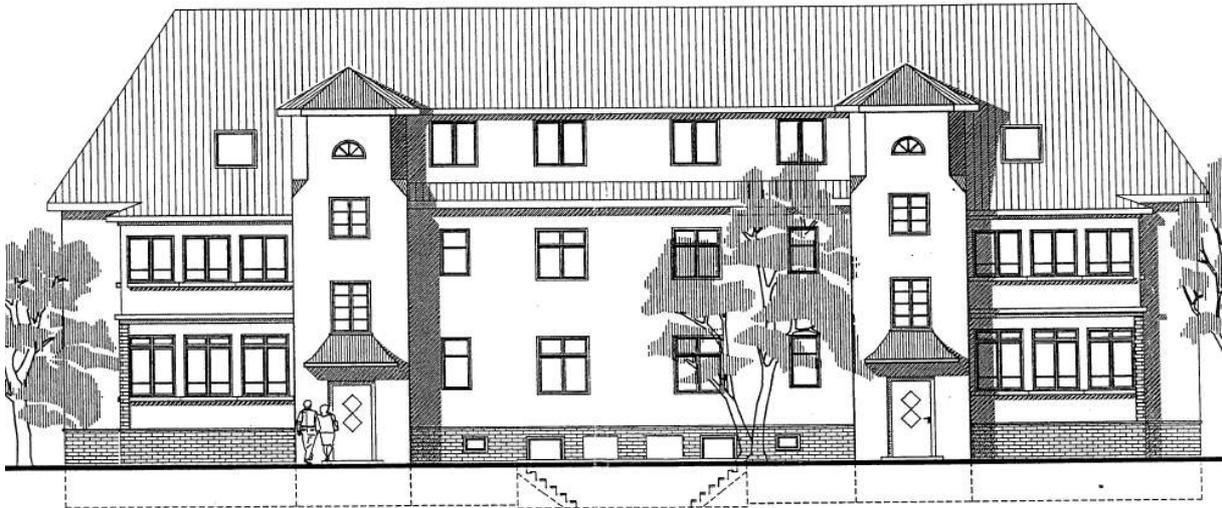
Ansicht Vorderfront (Eingangsseite), Planausschnitt o.M.
